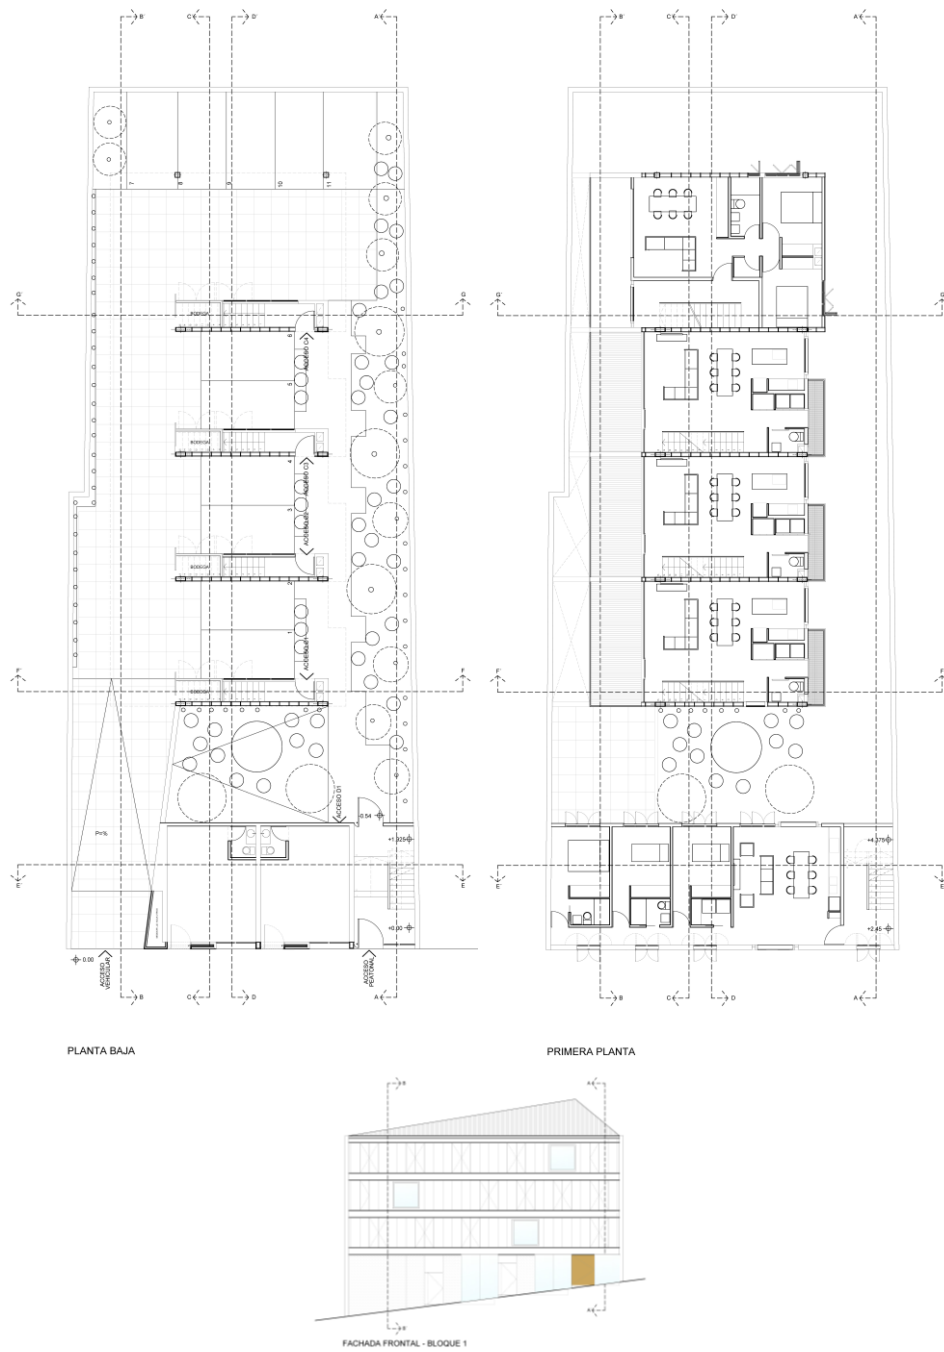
Plantas y fachada principal del proyecto de obra nueva. Fuente: cortesía de Yes Innovation
